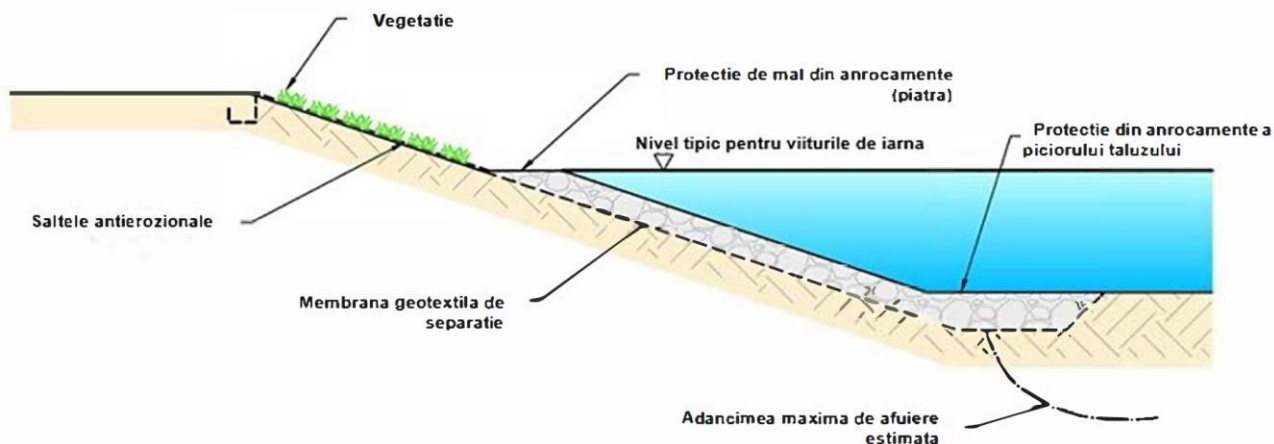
Sectiune transversala aparare de mal cu anrocamente si saltele pre-insamantate antierozionale
